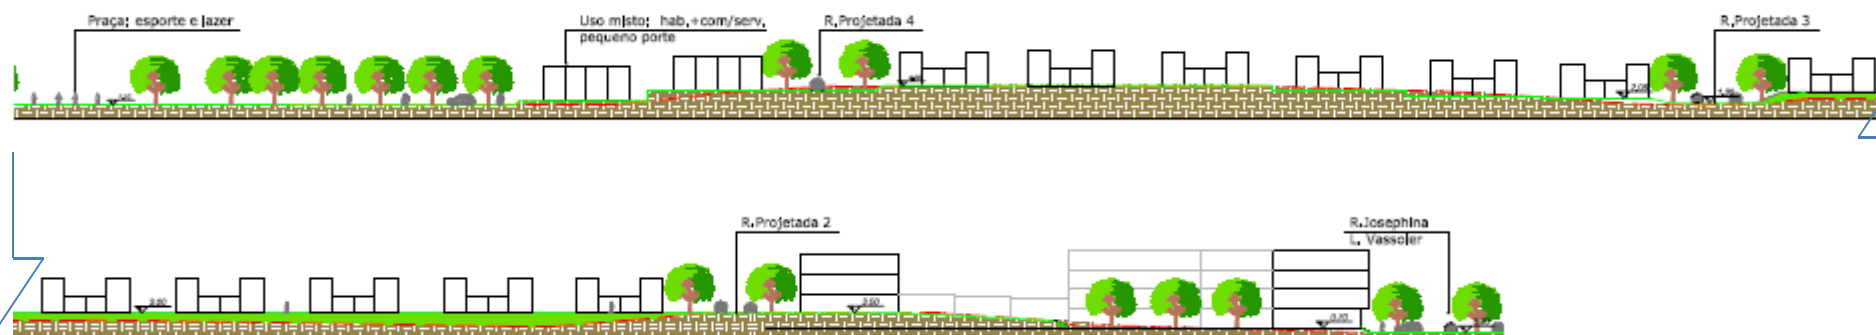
Corte longitudinal (A-A): Linha original do terreno (vermelho tracejada) e alterações propostas em verde.
